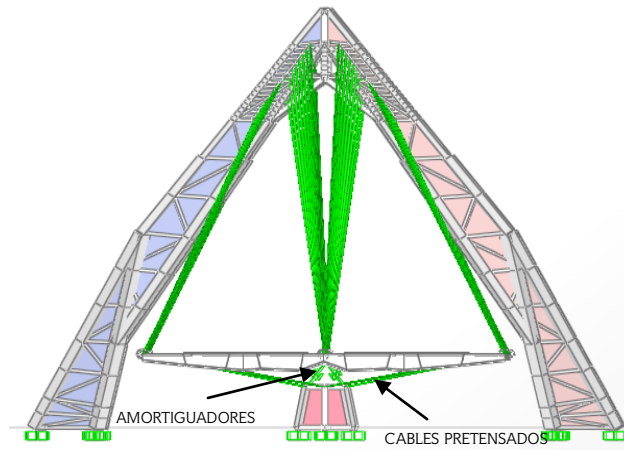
Corte transversal del puente con amortiguadores y cables pretensados
